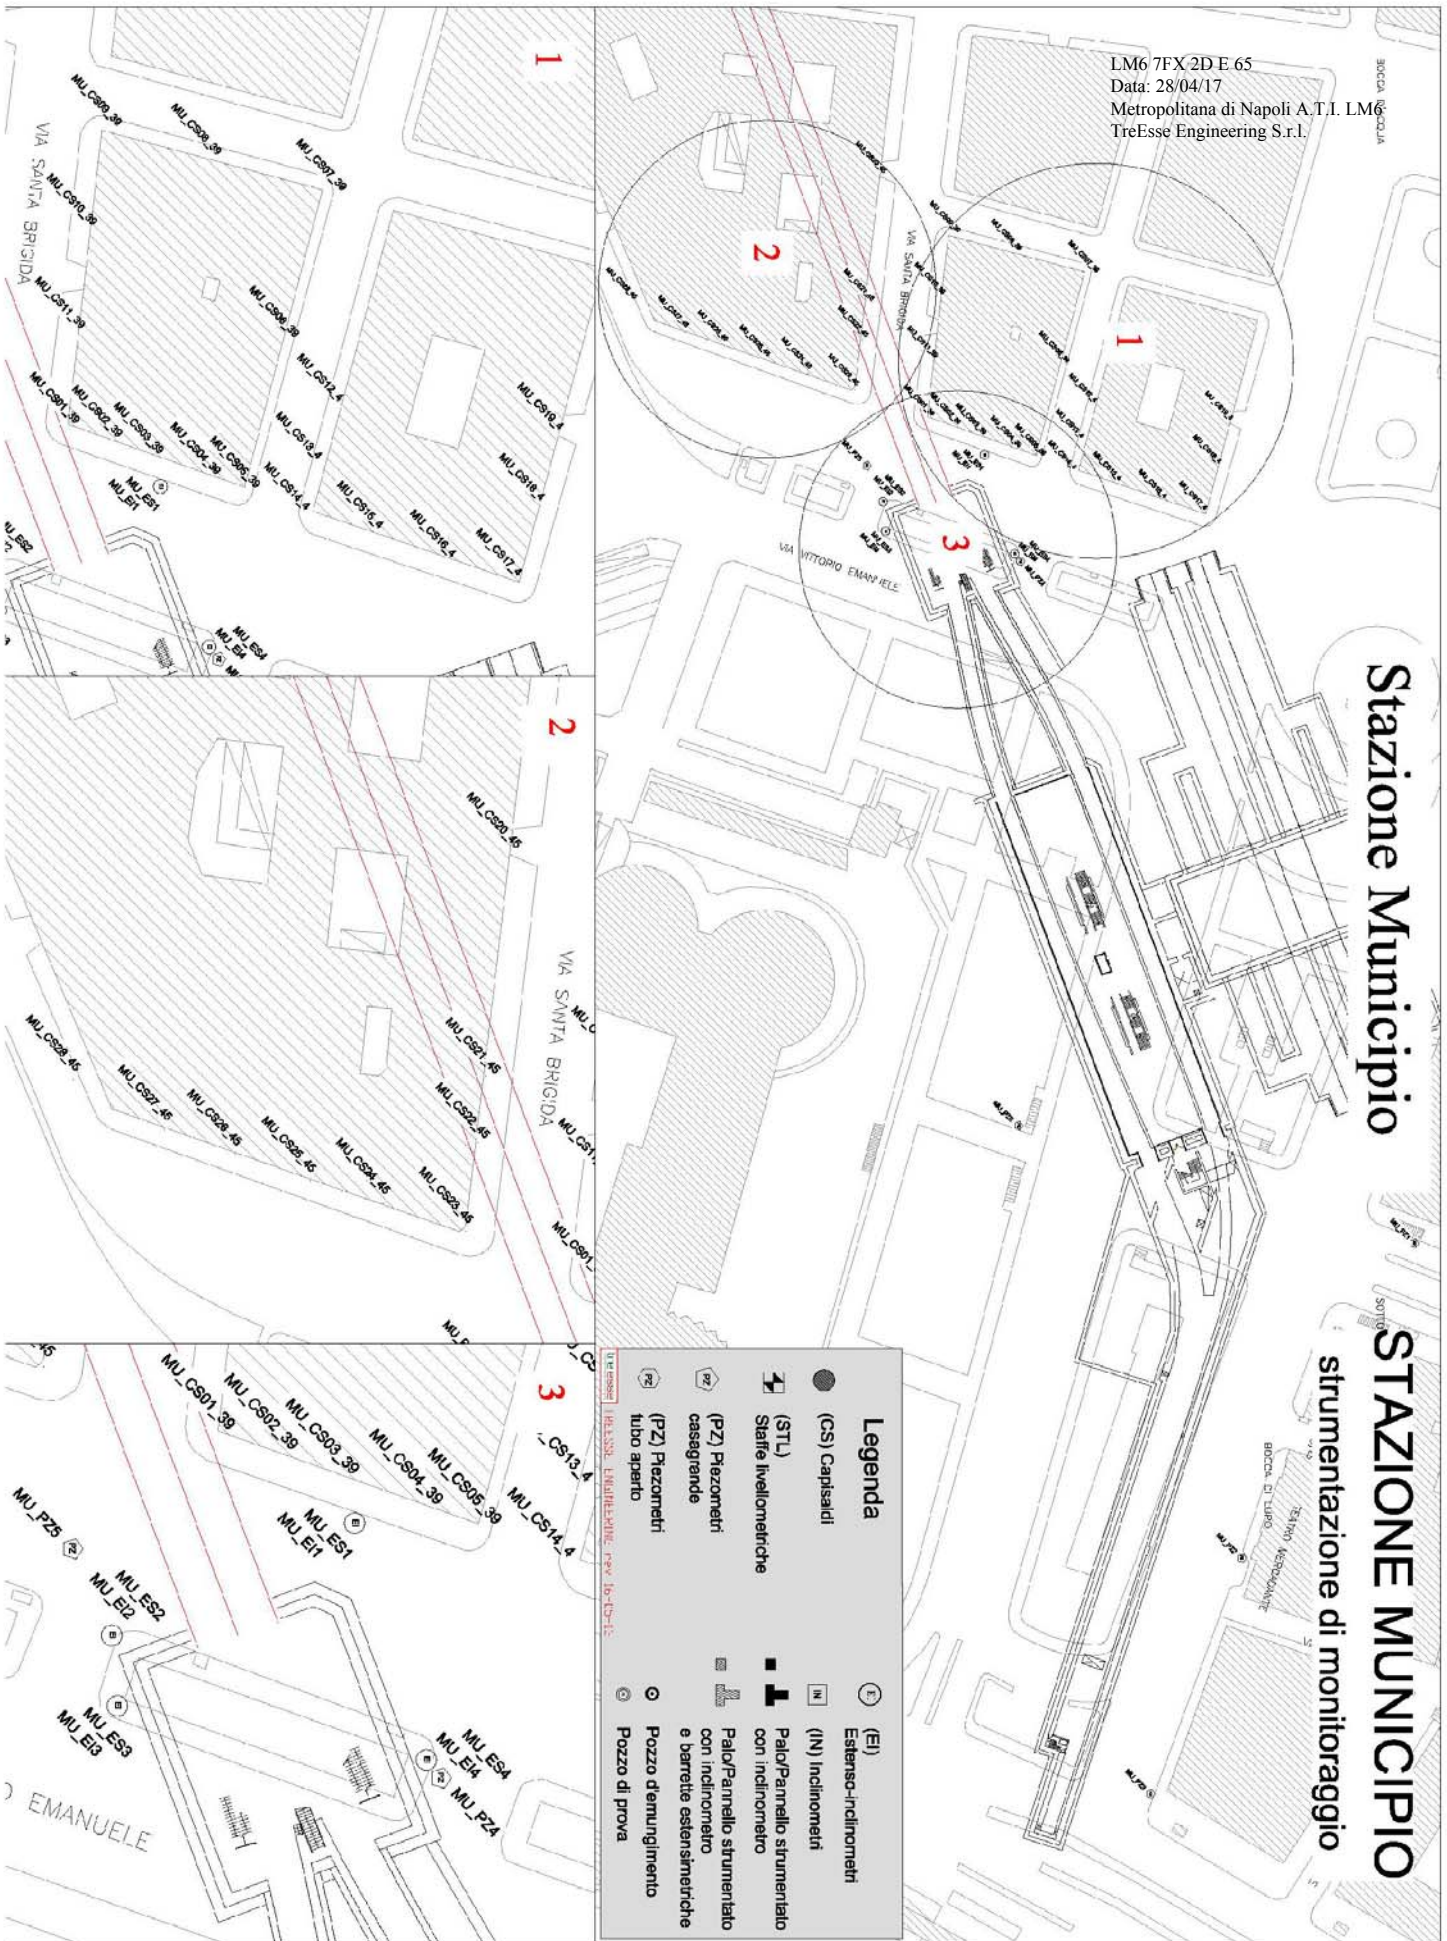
Planimetria pozzo stazione, raffigurante la disposizione della strumentazione di monitoraggio topografico e geotecnico esterna.
